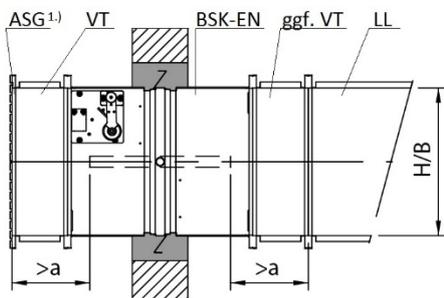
Exemple de raccordement d'un conduit d'aération disposé d'un seul côté et grille de protection
